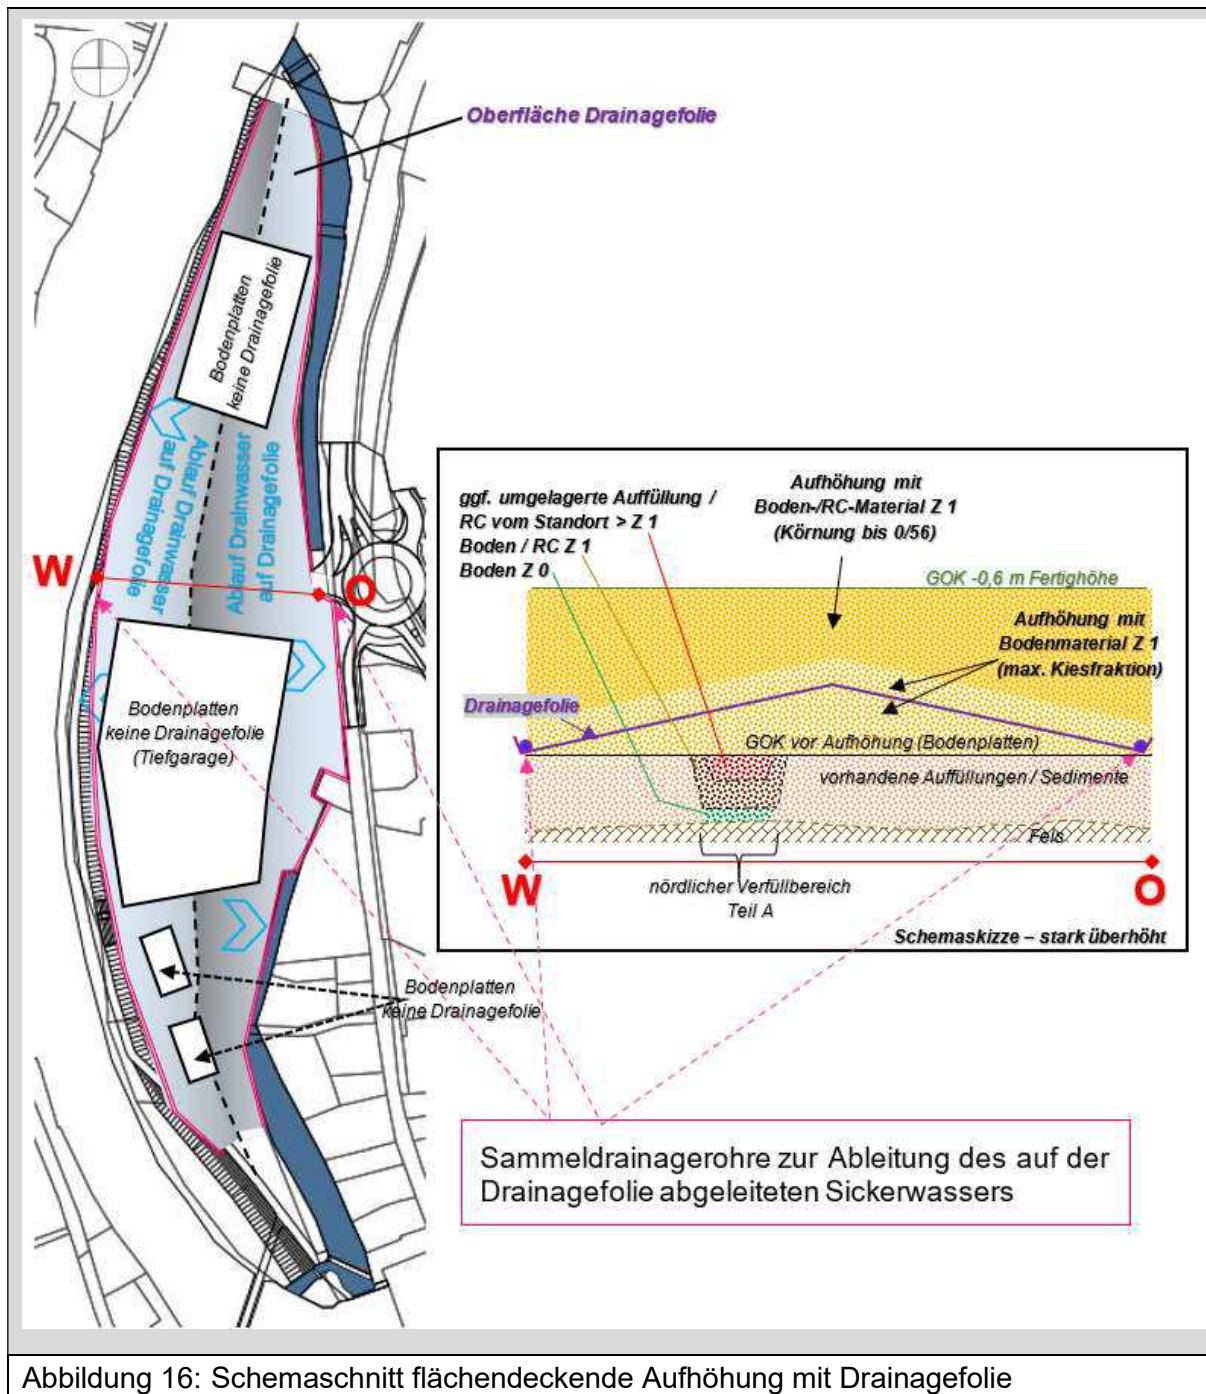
Schemaschnitt flächendeckende Aufhöhung mit Drainagefolie
